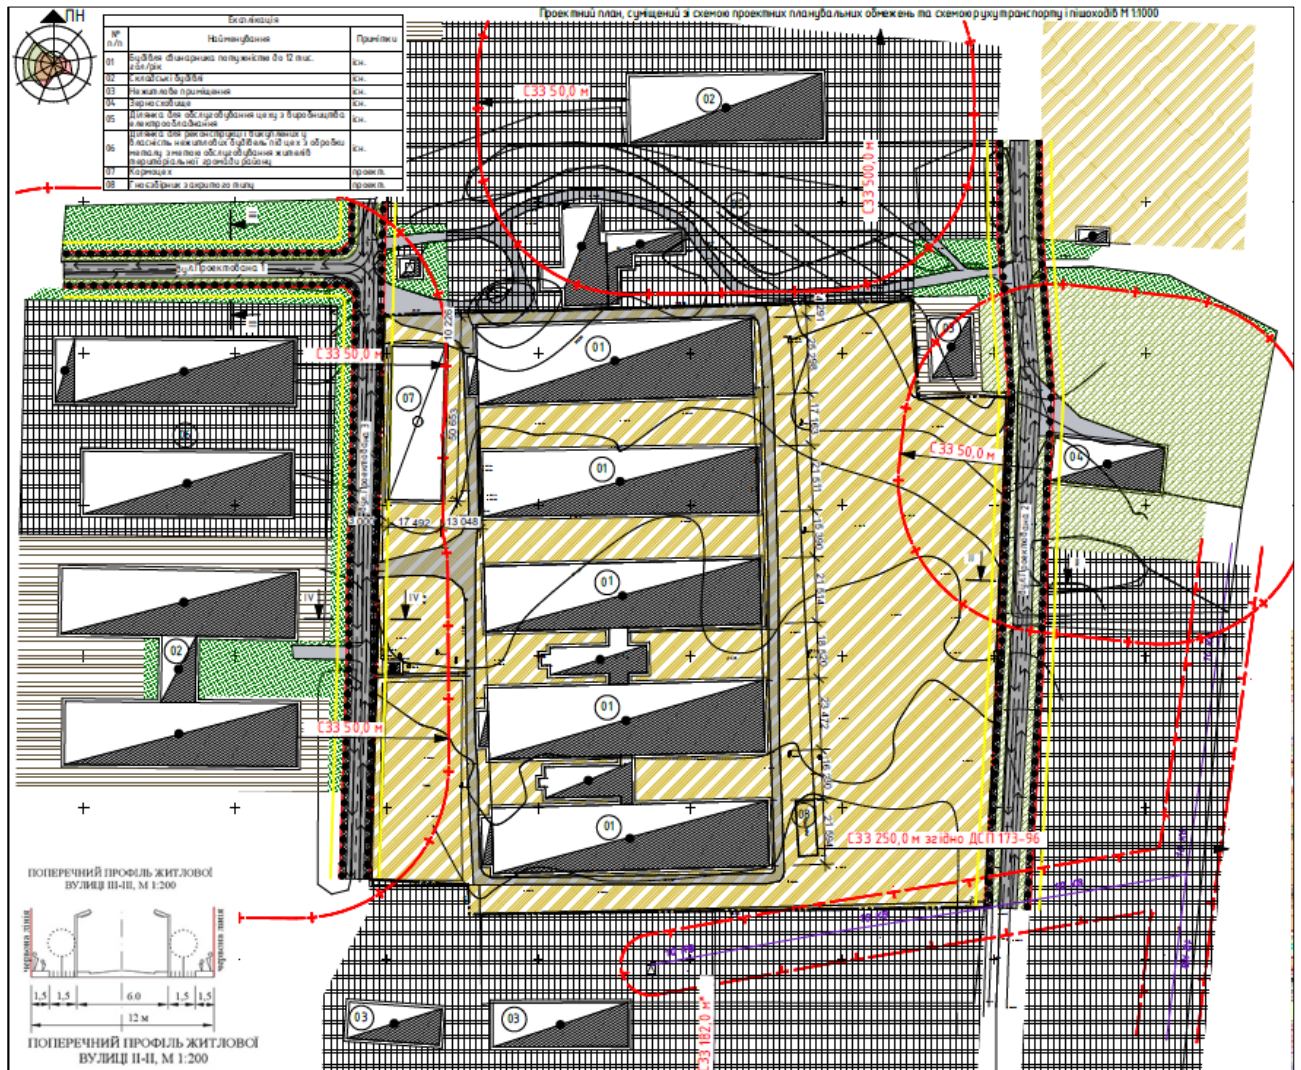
Проектний план території (основне креслення) та планувальні обмеження
